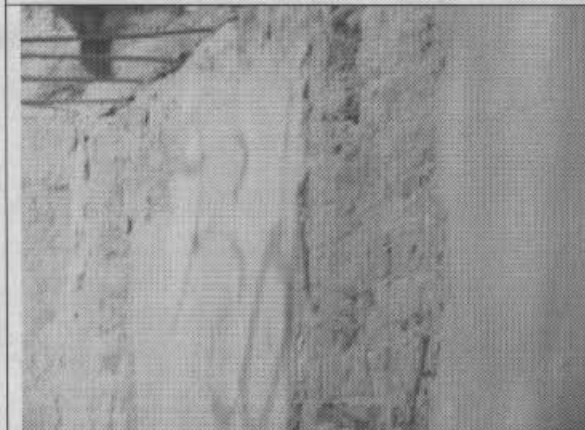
Desprendimiento de mampostería en apoyo de placa.
